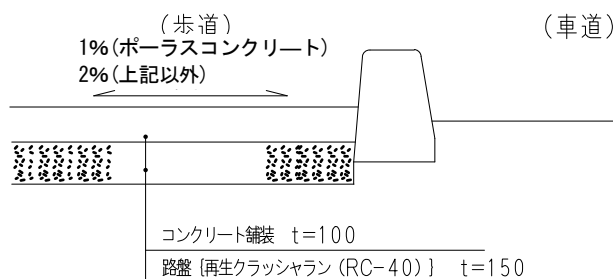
36 コンクリート舗装の構成例 (単位 : mm)
